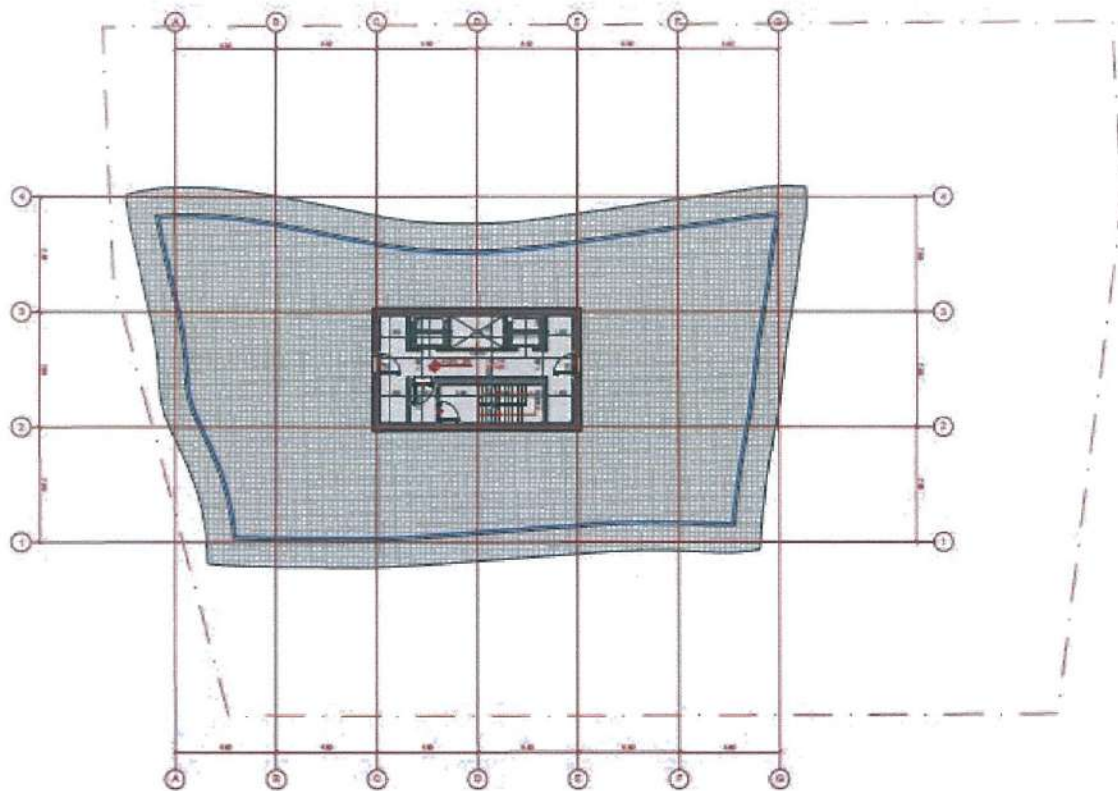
Planimetria e katit 22, në kuotën +86.36 SIP 106 m²
